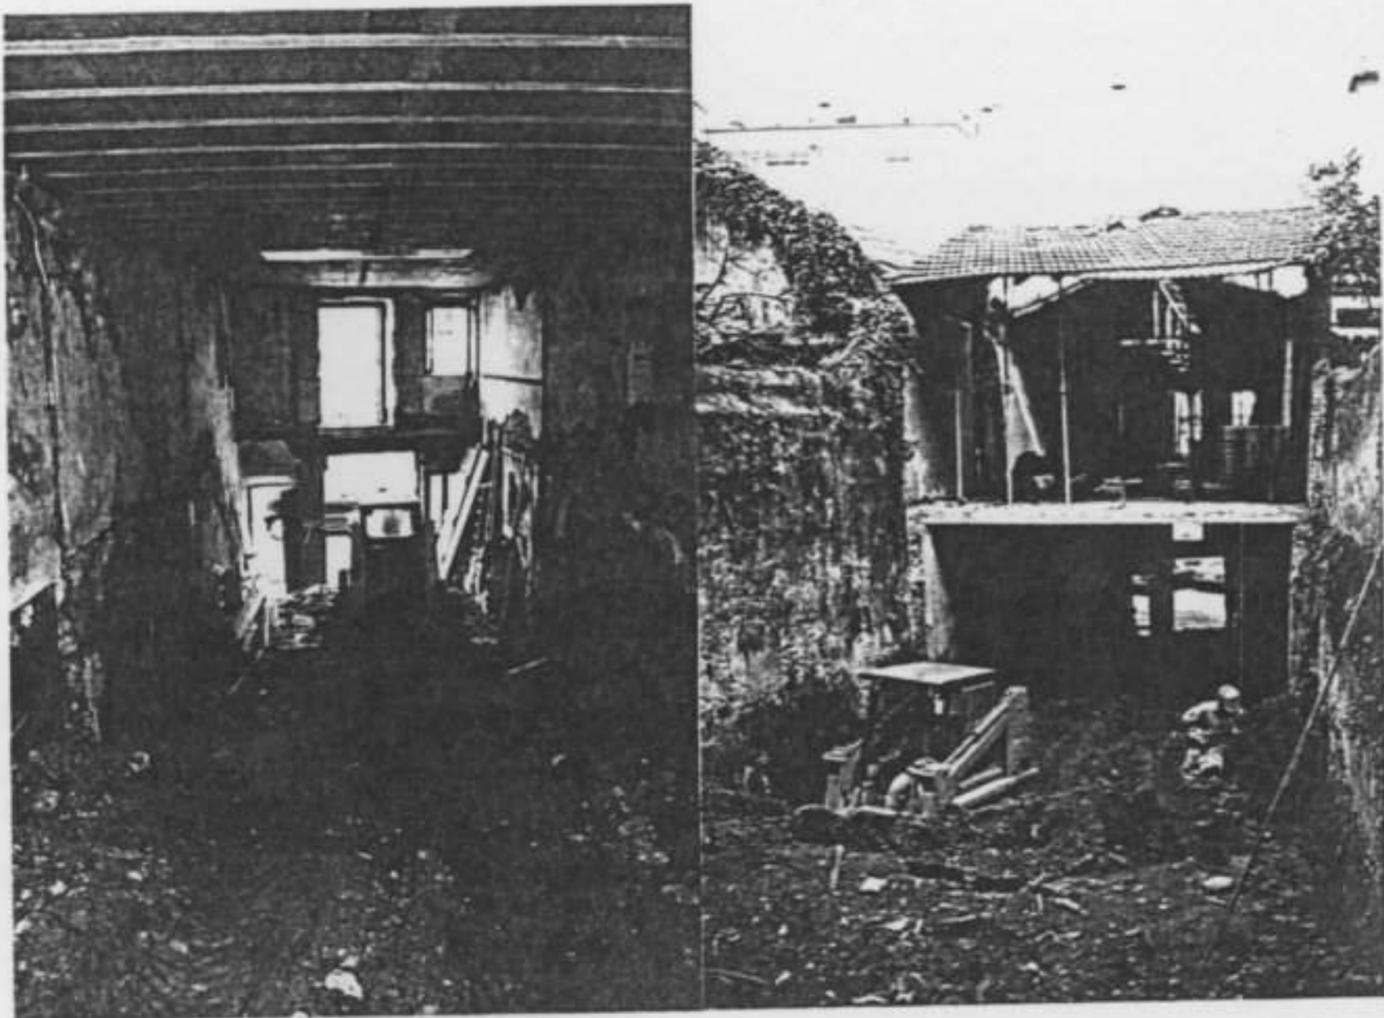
e 13 – Alargamento de um vão da fachada para permitir a entrada de equipamento para remoção de terras
